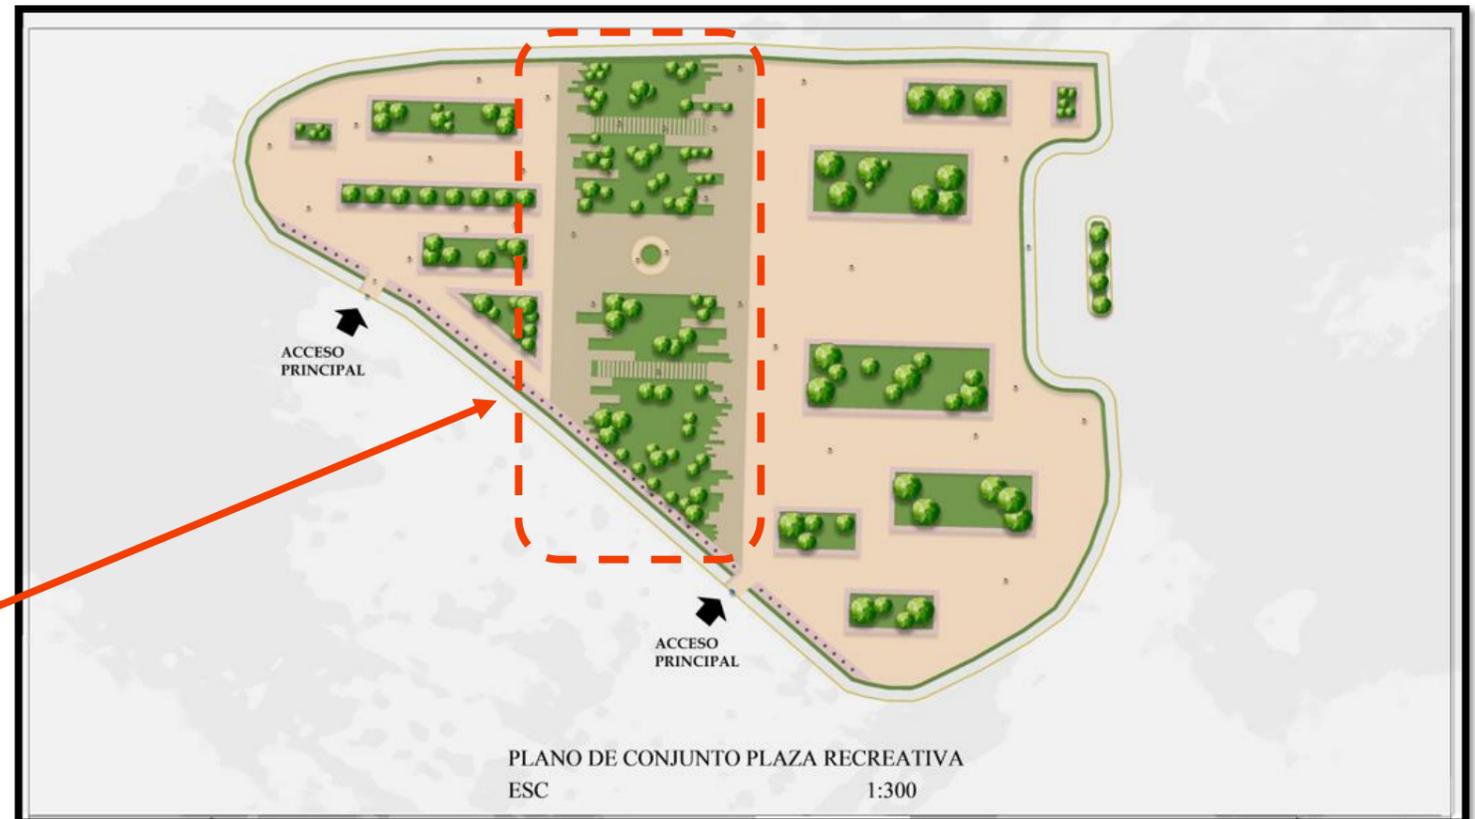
Conjunto de ubicación de la caja puente, Fuente; Autores
